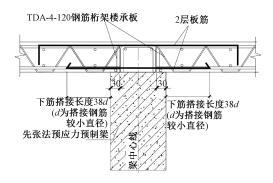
2 层桁架楼承板铺装节点剖面 Fig. 9 Section of 2-layer truss floor slab pavement joint
